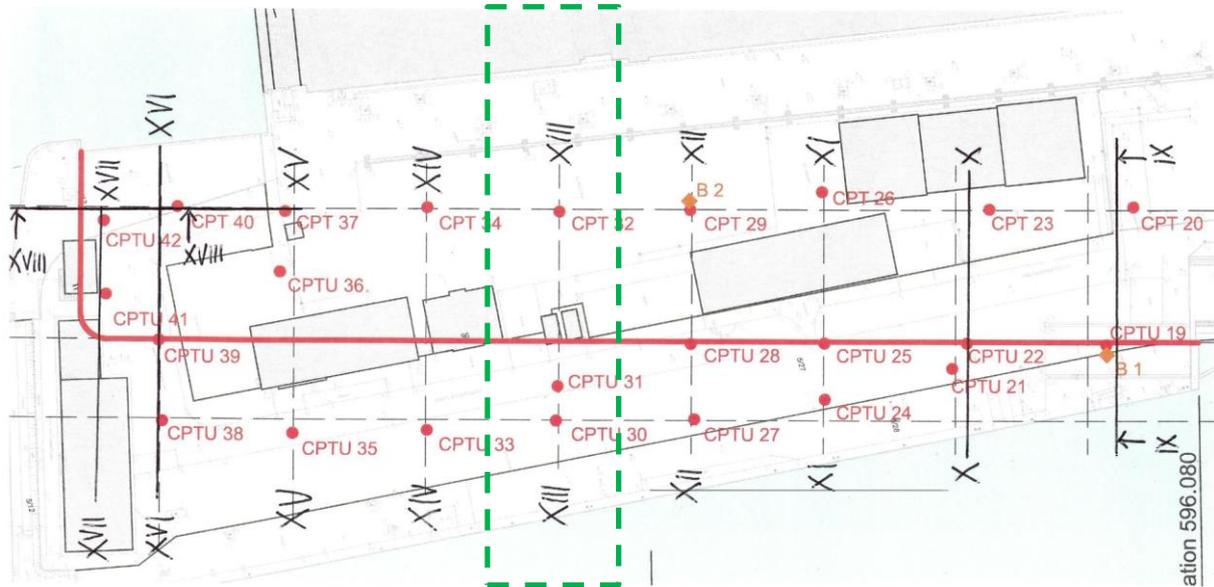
Bemessungsprofil XIII - Lage [U1]
